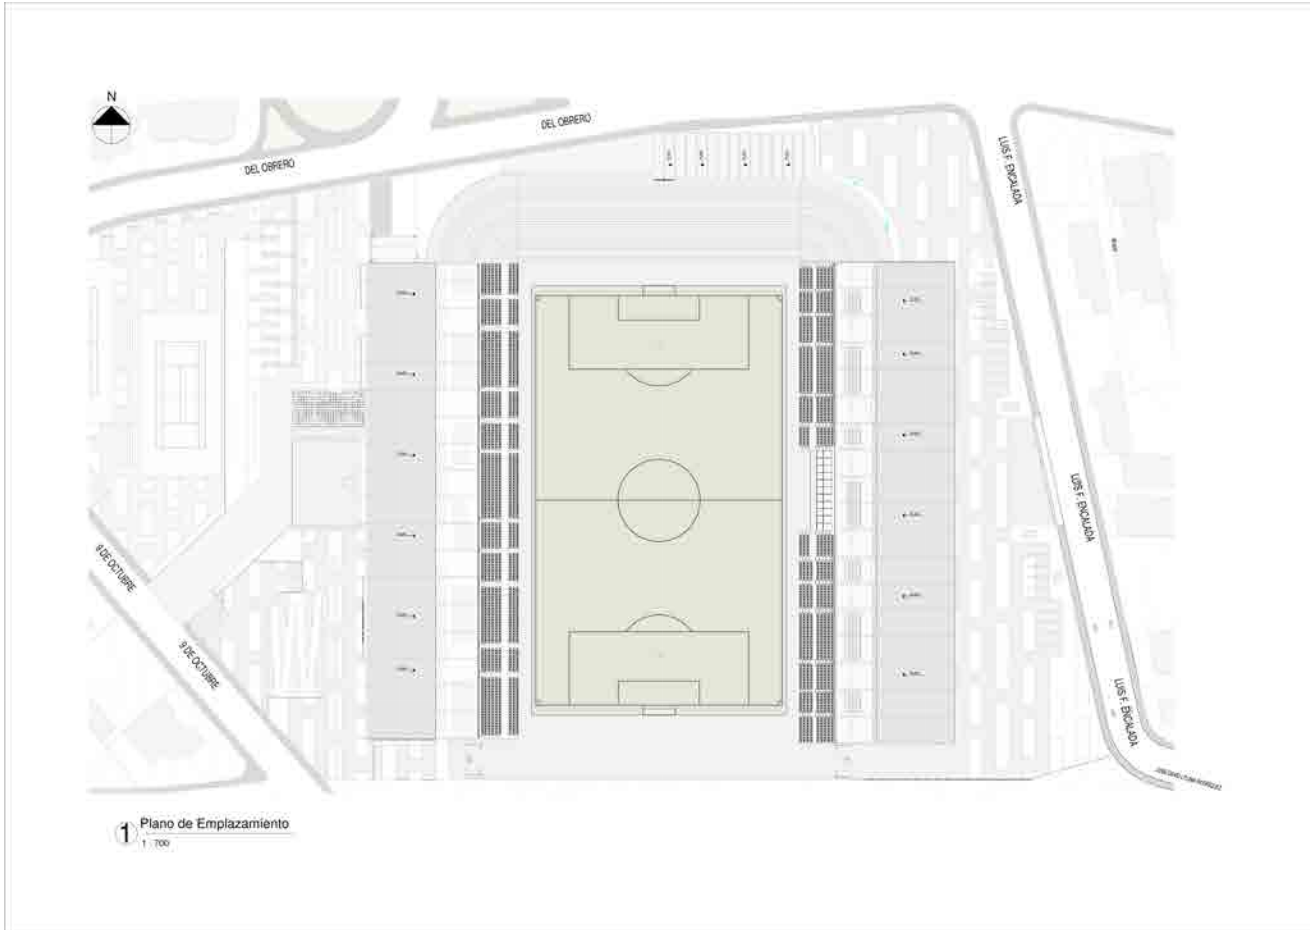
Emplazamiento/Cubiertas. Elaboración: Autores.
